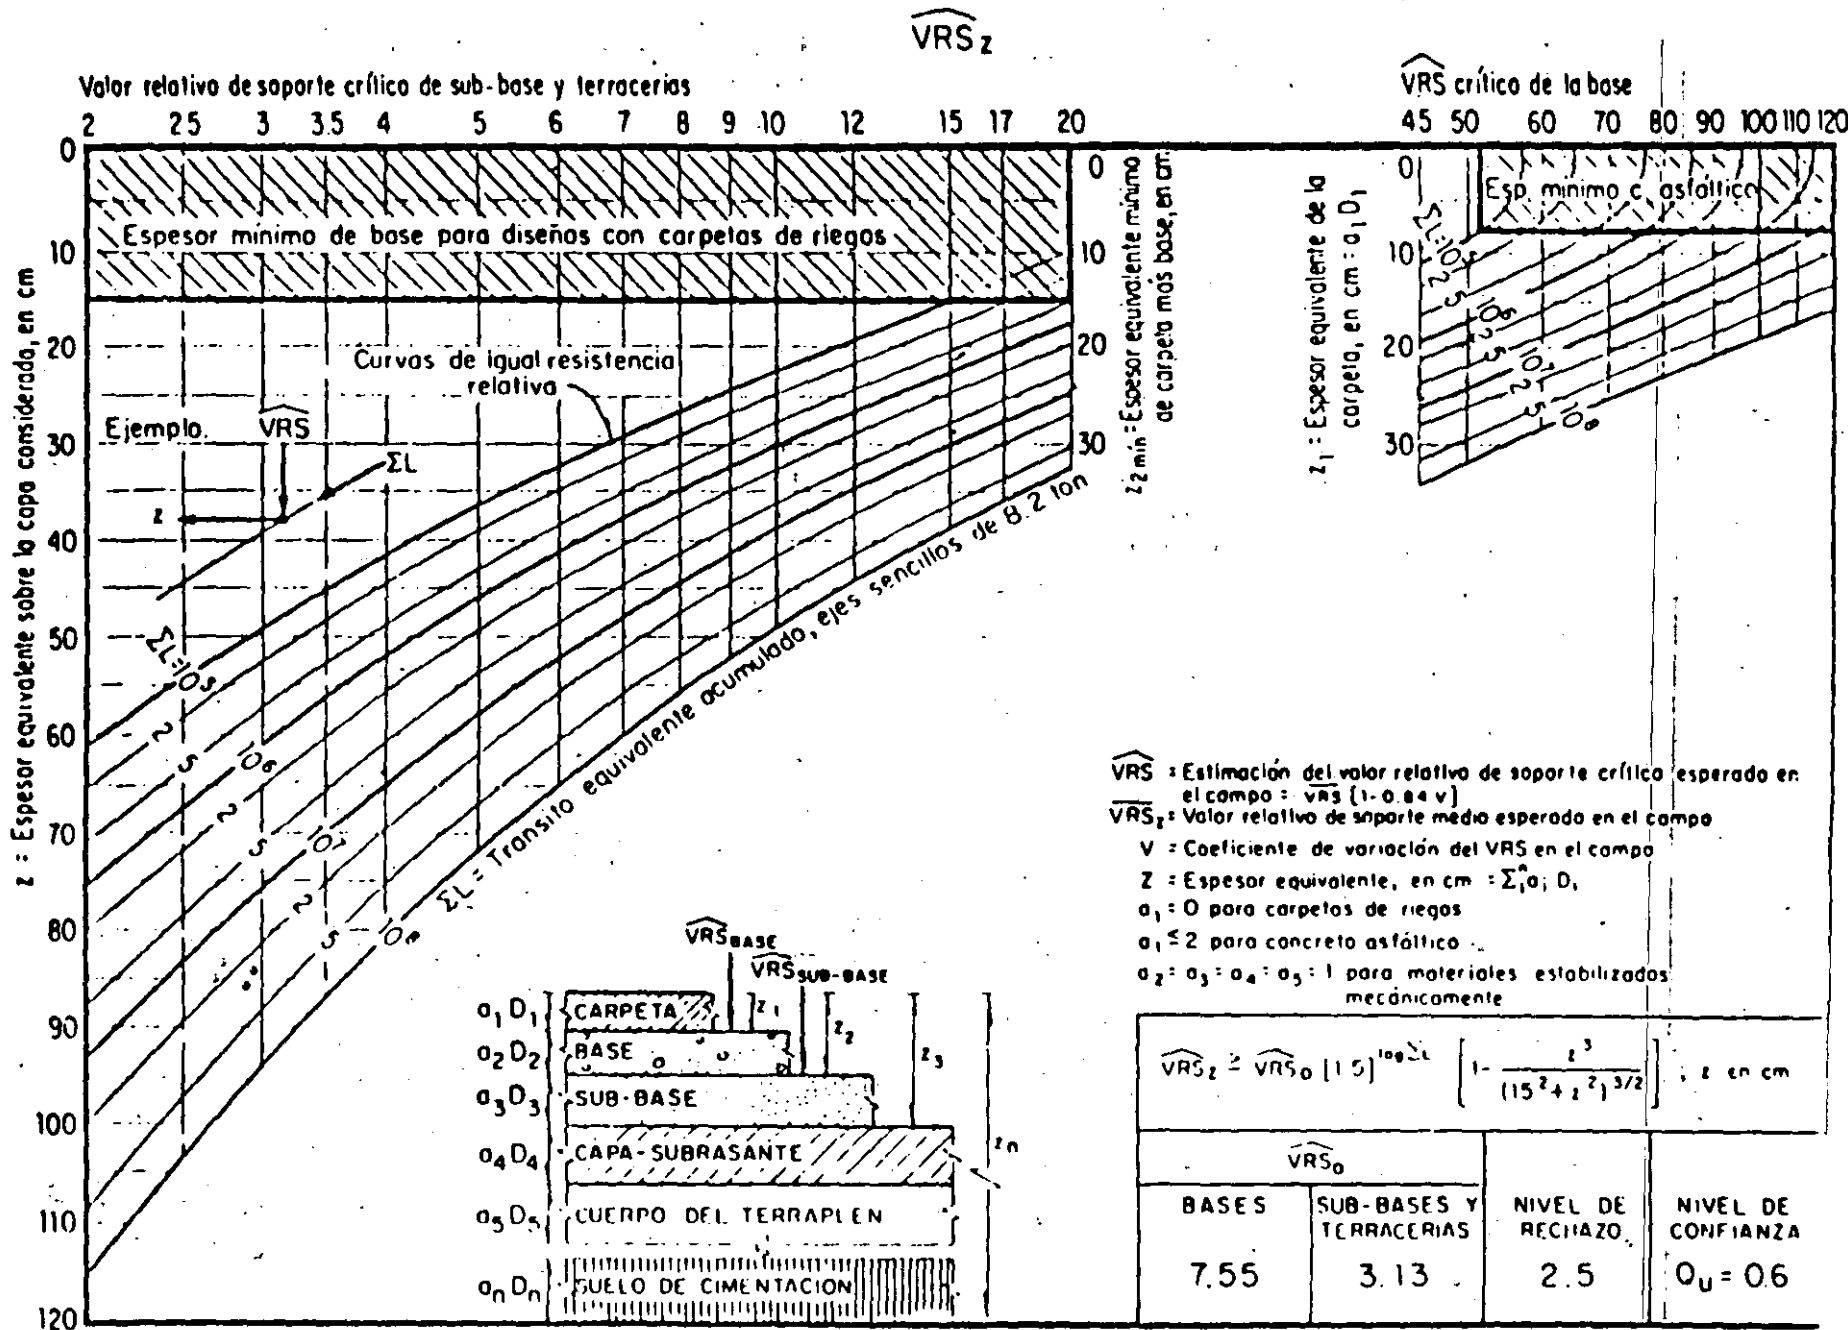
Gráfica para el diseño estructural de carreteras con pavimento flexible.
